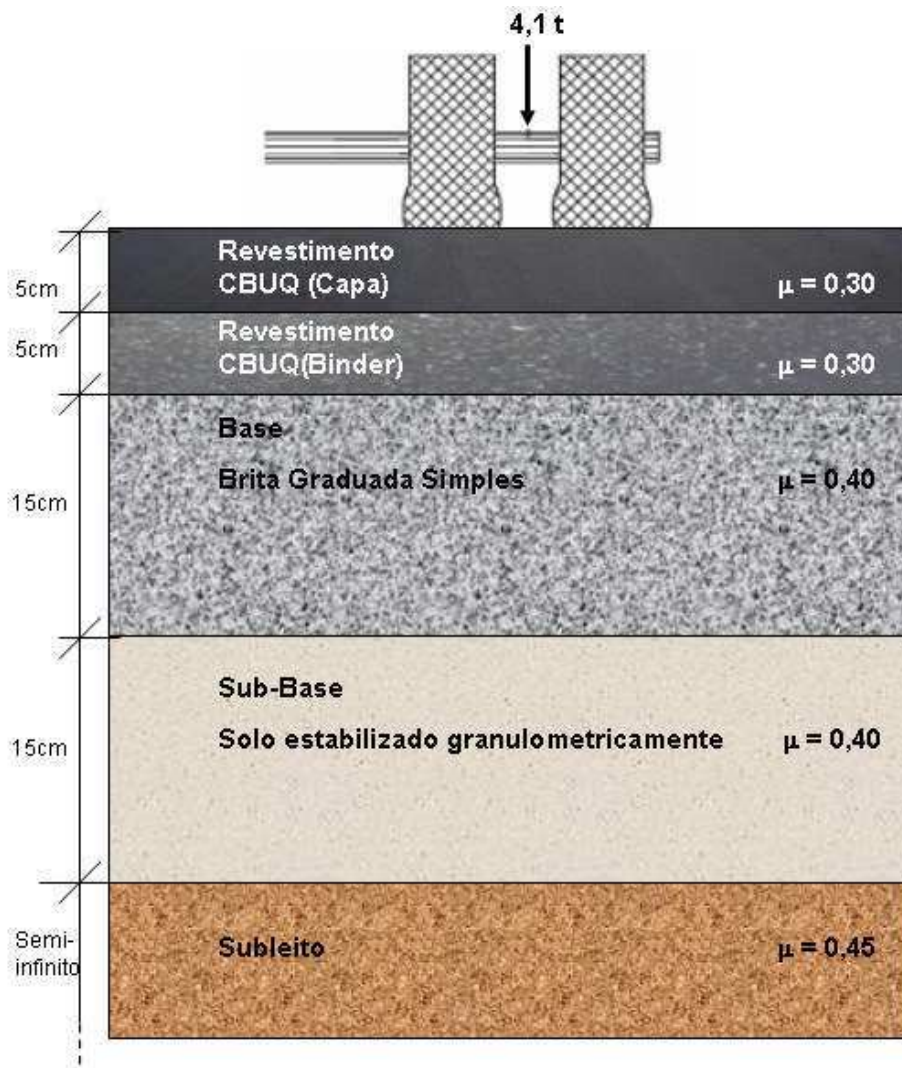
Estrutura de pavimento analisada para BR232PE.
